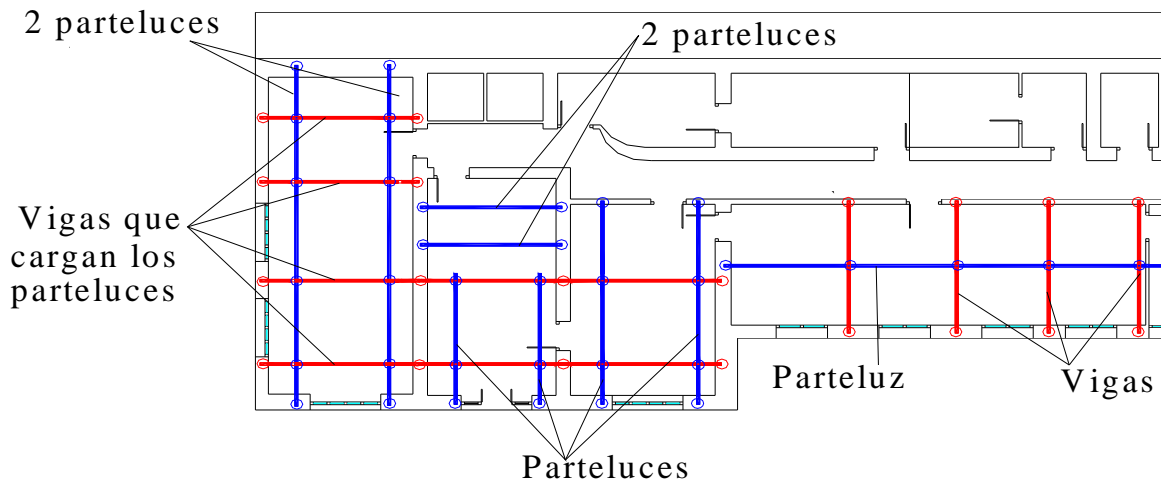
Planta parcial de los refuerzos de un forjado que no satisfacía la normativa de estructuras, a base de "parteluces" y "vigas cargadero" sobre muros de carga.
